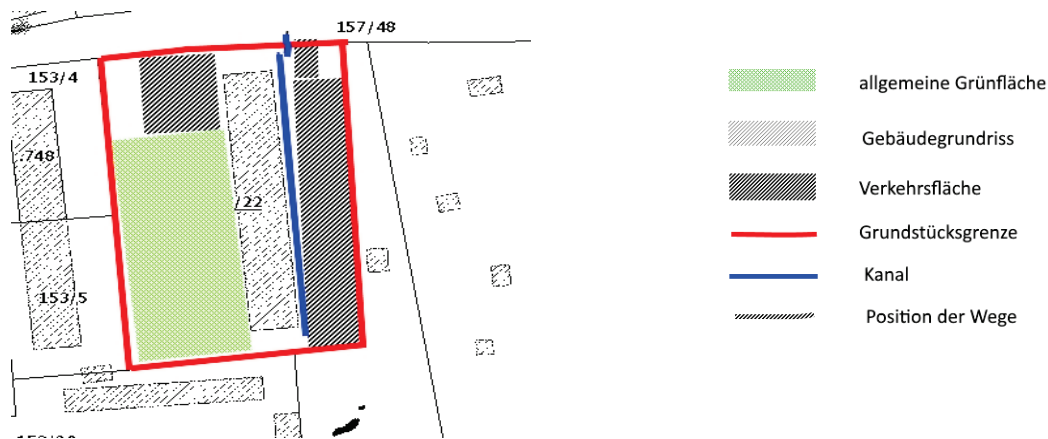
Lageplan für die Anlage "Plusenergiesanierung Kapfenberg", mit Gebäudegrundriss und Grundstücksgrenze. Verkehrsflächen, allgemeine Grünflächen und Position des Kanals wurden aus Orthophotos abgeleitet. Bearbeiten Daten aus ©GIS Steiermark – 2018.
